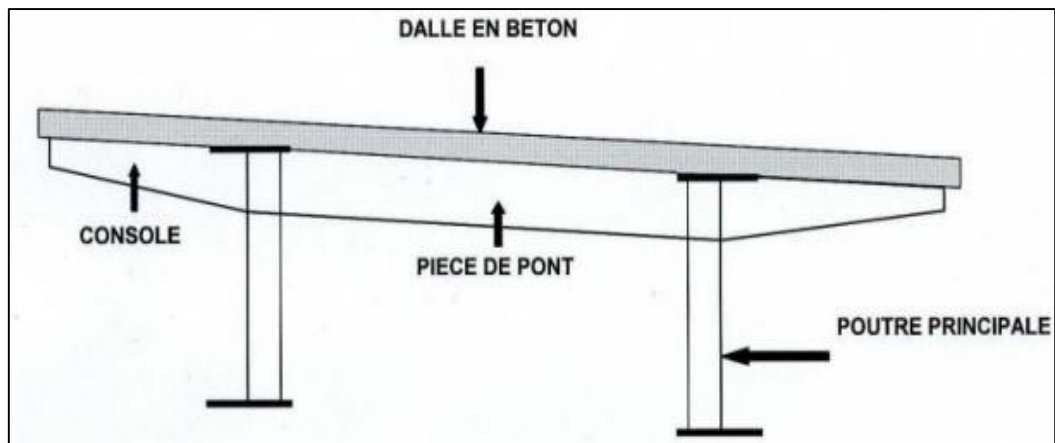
Coupe transversale d'un tablier bipoutre avec console.
